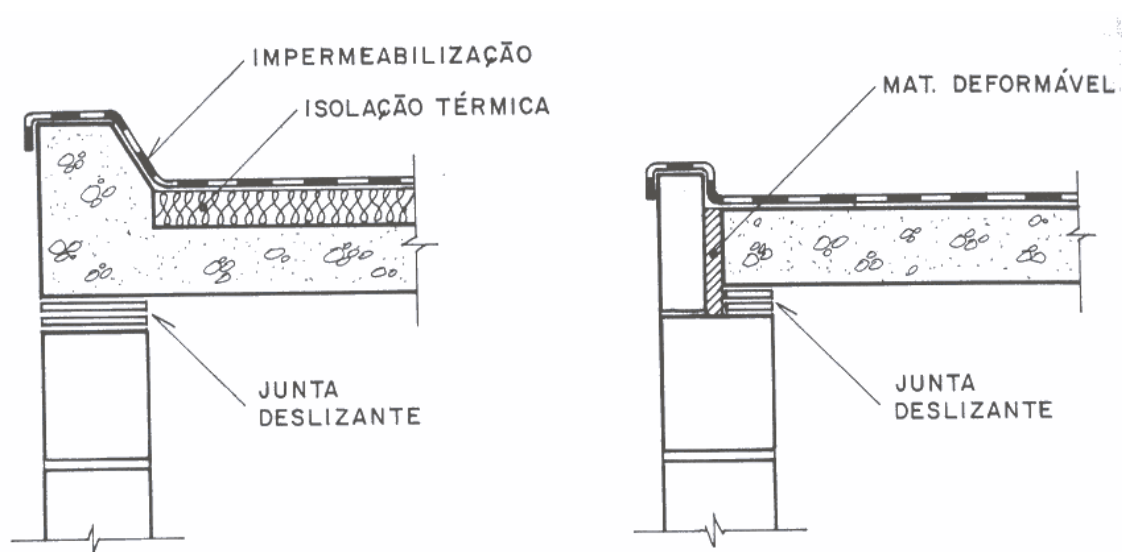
Junta deslizante entre a laje de cobertura e a alvenaria estrutural.
